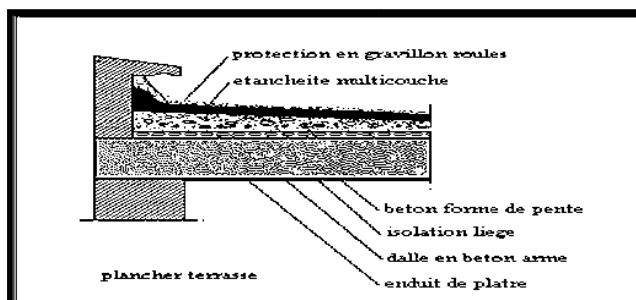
Schéma Plancher terrasse inaccessible Fig II.11:Schéma plancher E.C + R.D.C
